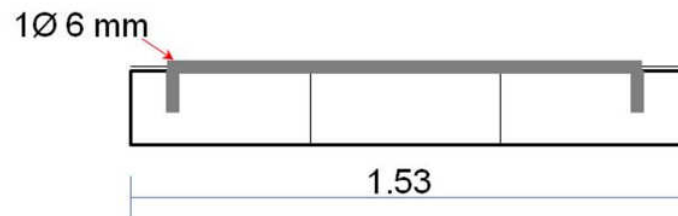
Esquema de refuerzo horizontal para murete M3.
